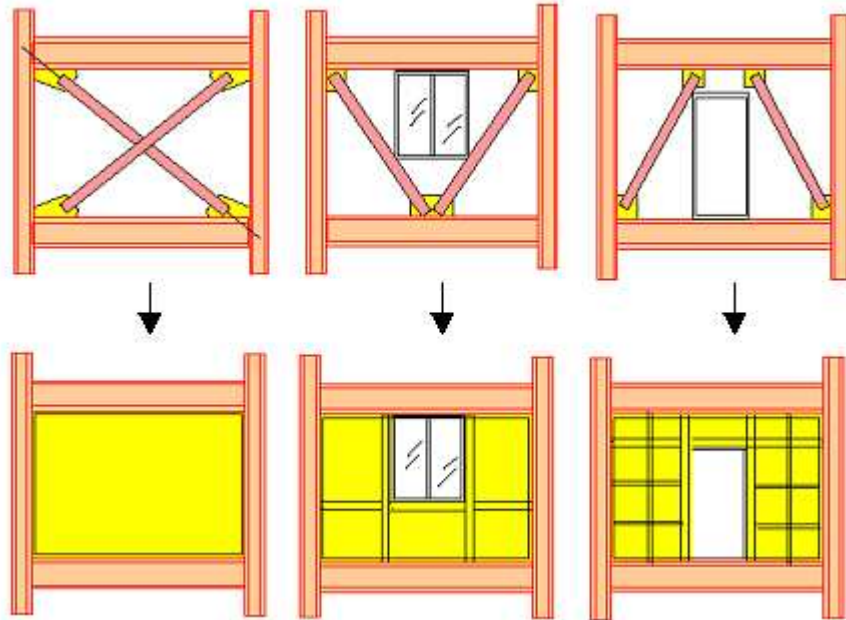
Betonarme perde destek bağlantılı çerçeve sistemler
